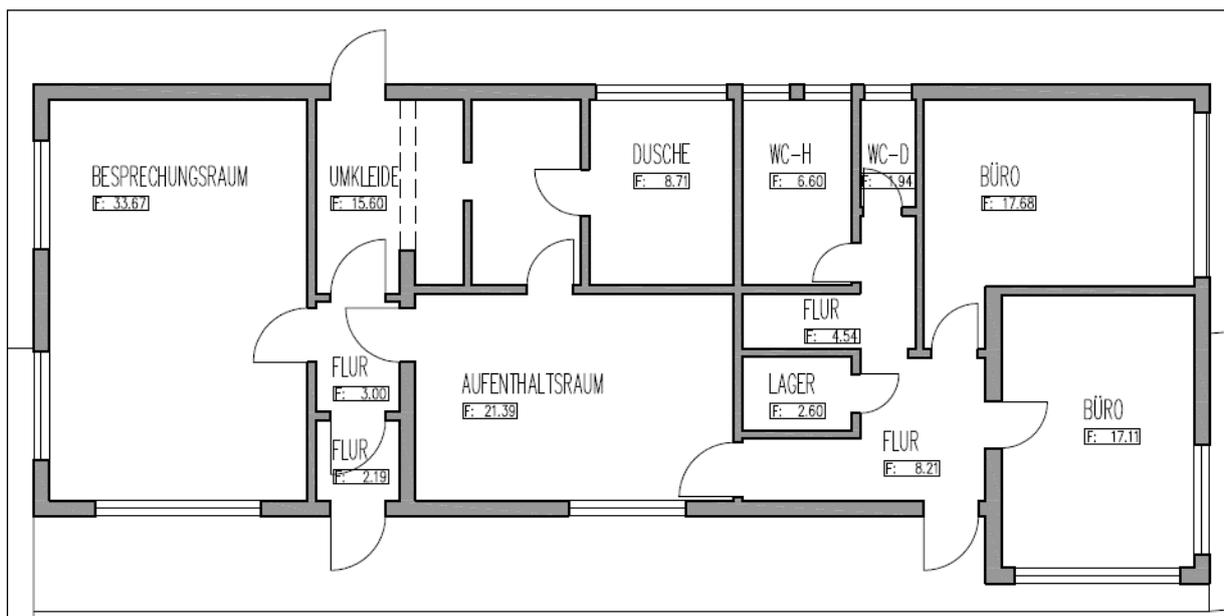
Grundriss Bestandsgebäude (Achtung: Wandstärken angenommen)
